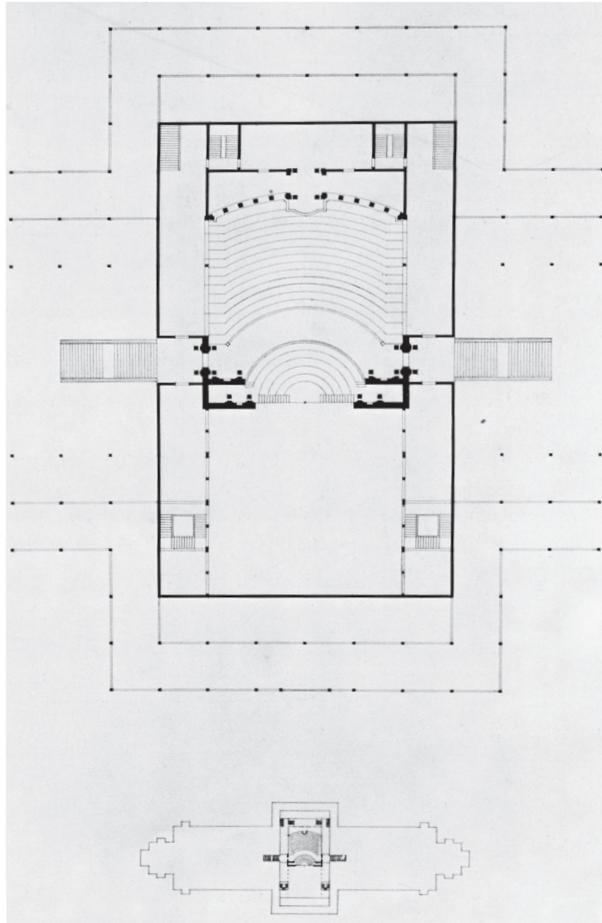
Projekt C. Theater im Glaspalast, zwei Grundrisse³²
